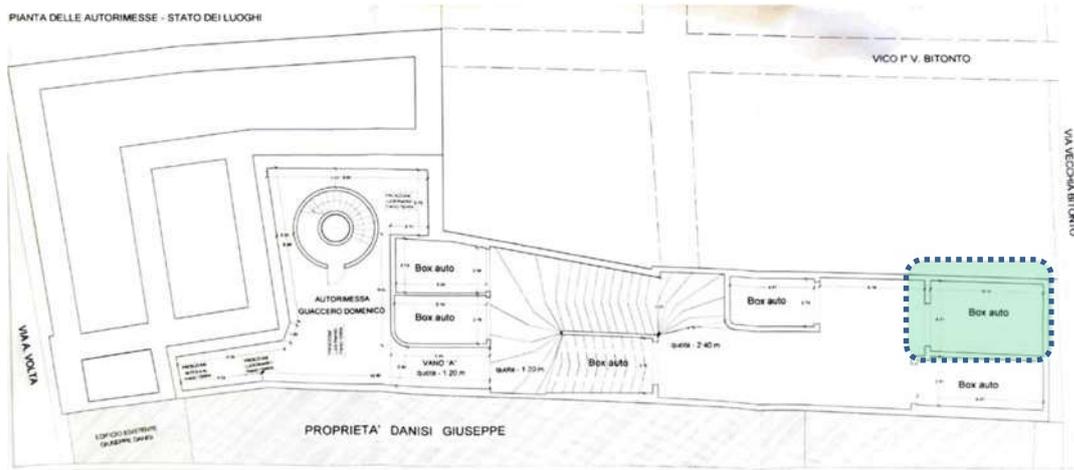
BENE N- Stralcio planimetria di progetto D.I.A. n. 10098 del 15.06.2011
